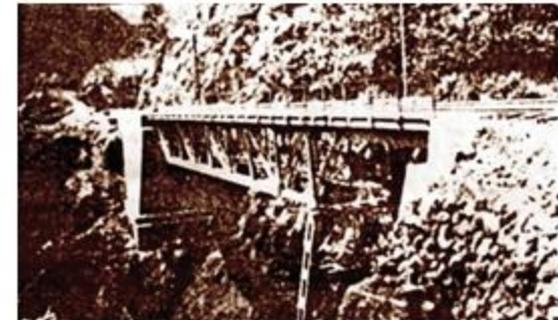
Puente en Cantel, 1930. Fuente: El Imparcial.
